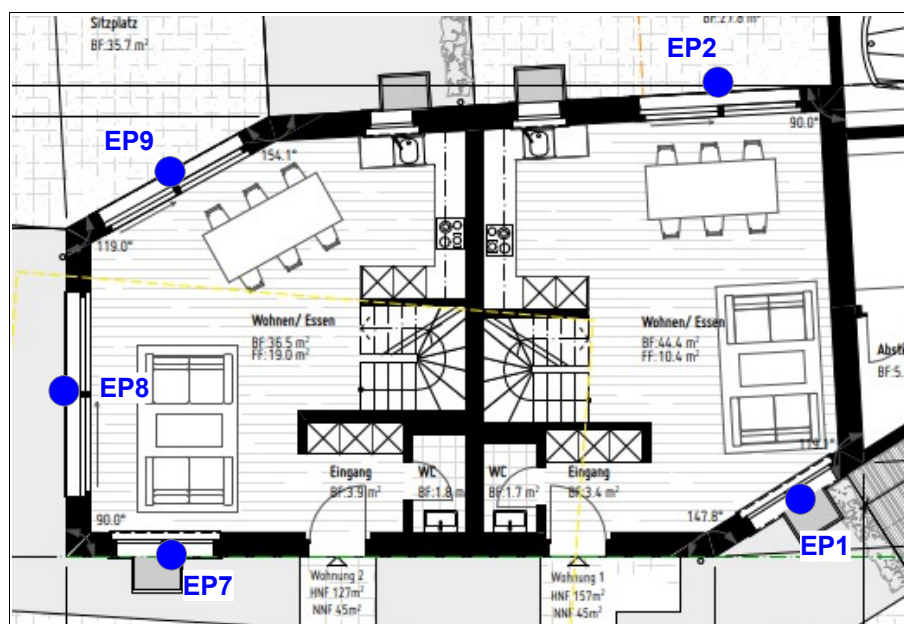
Grundriss EG, ohne Mst.; Quelle: Architekt
